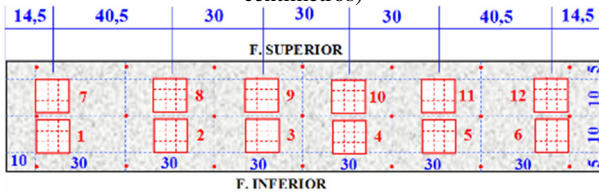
Áreas de ensaios nas vigas (dimensões em centímetros)
